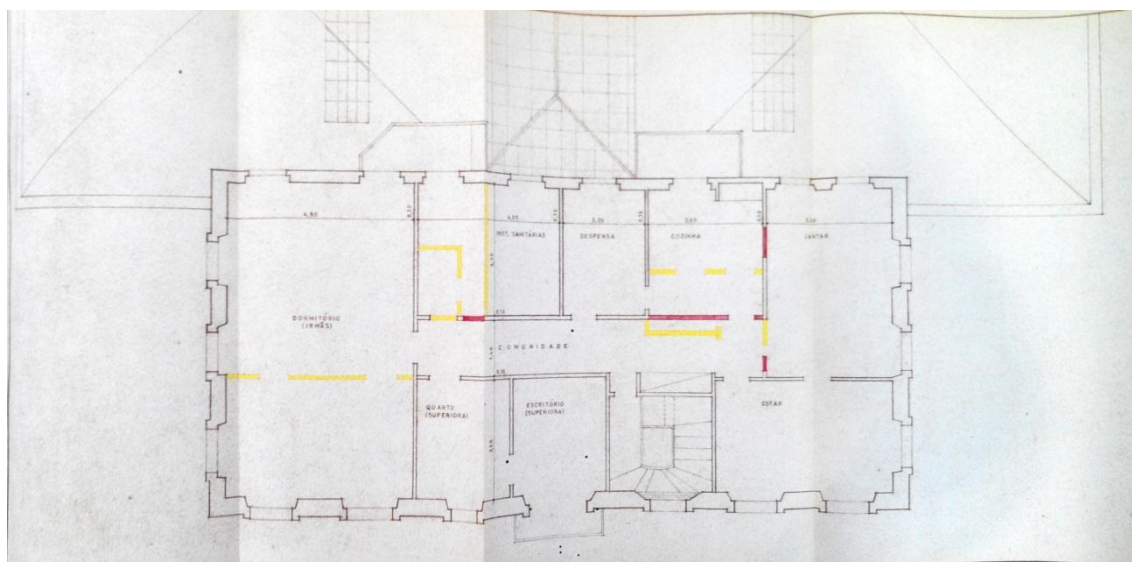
Projecto de remodelação e melhoria de 1963: Planta do 4.º pavimento; sem escala
